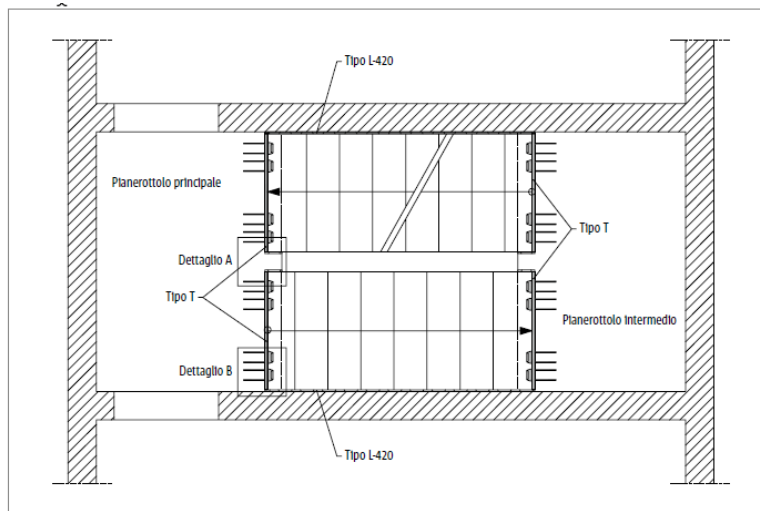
Schöck Tronsole® tipo T, disposizione dell'elemento in pianta
